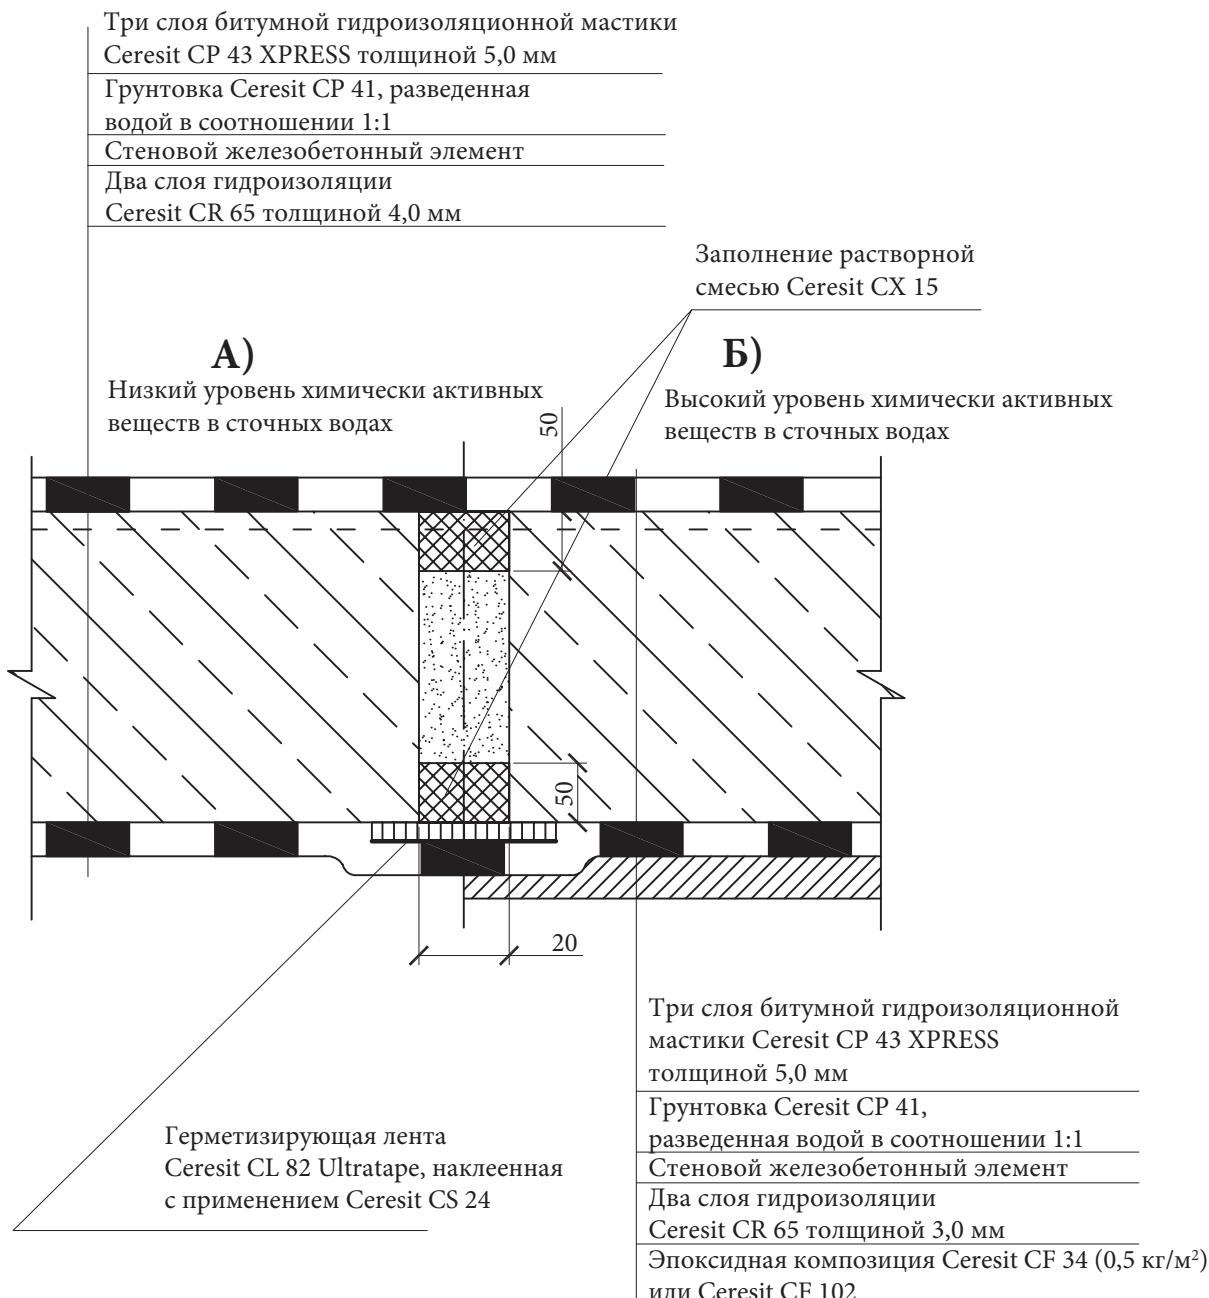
Конструкция гидроизоляции вертикальных стыков между сборными стеновыми элементами железобетонных емкостей для сточных вод без защитного покрытия (А) и с защитным покрытием (Б)
